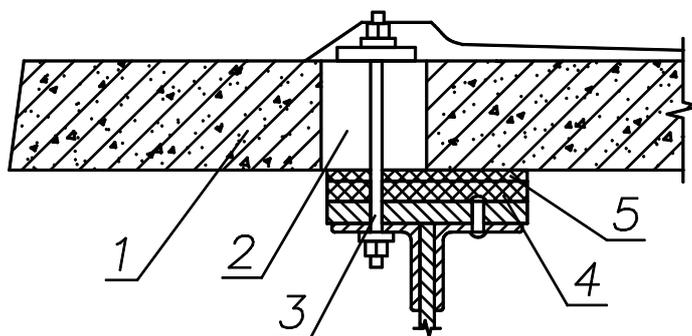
Конструкция прокладного слоя под железобетонными плитами безбалластного мостового полотна: 1 – плита БМП; 2 – овальное отверстие для высокопрочной шпильки (и нагнетания раствора под плиту); 3 – высокопрочная шпилька; 4 – антисептированная древесина (дуб); 5 – армированная тканью резиновая прокладка (транспортная лента)
